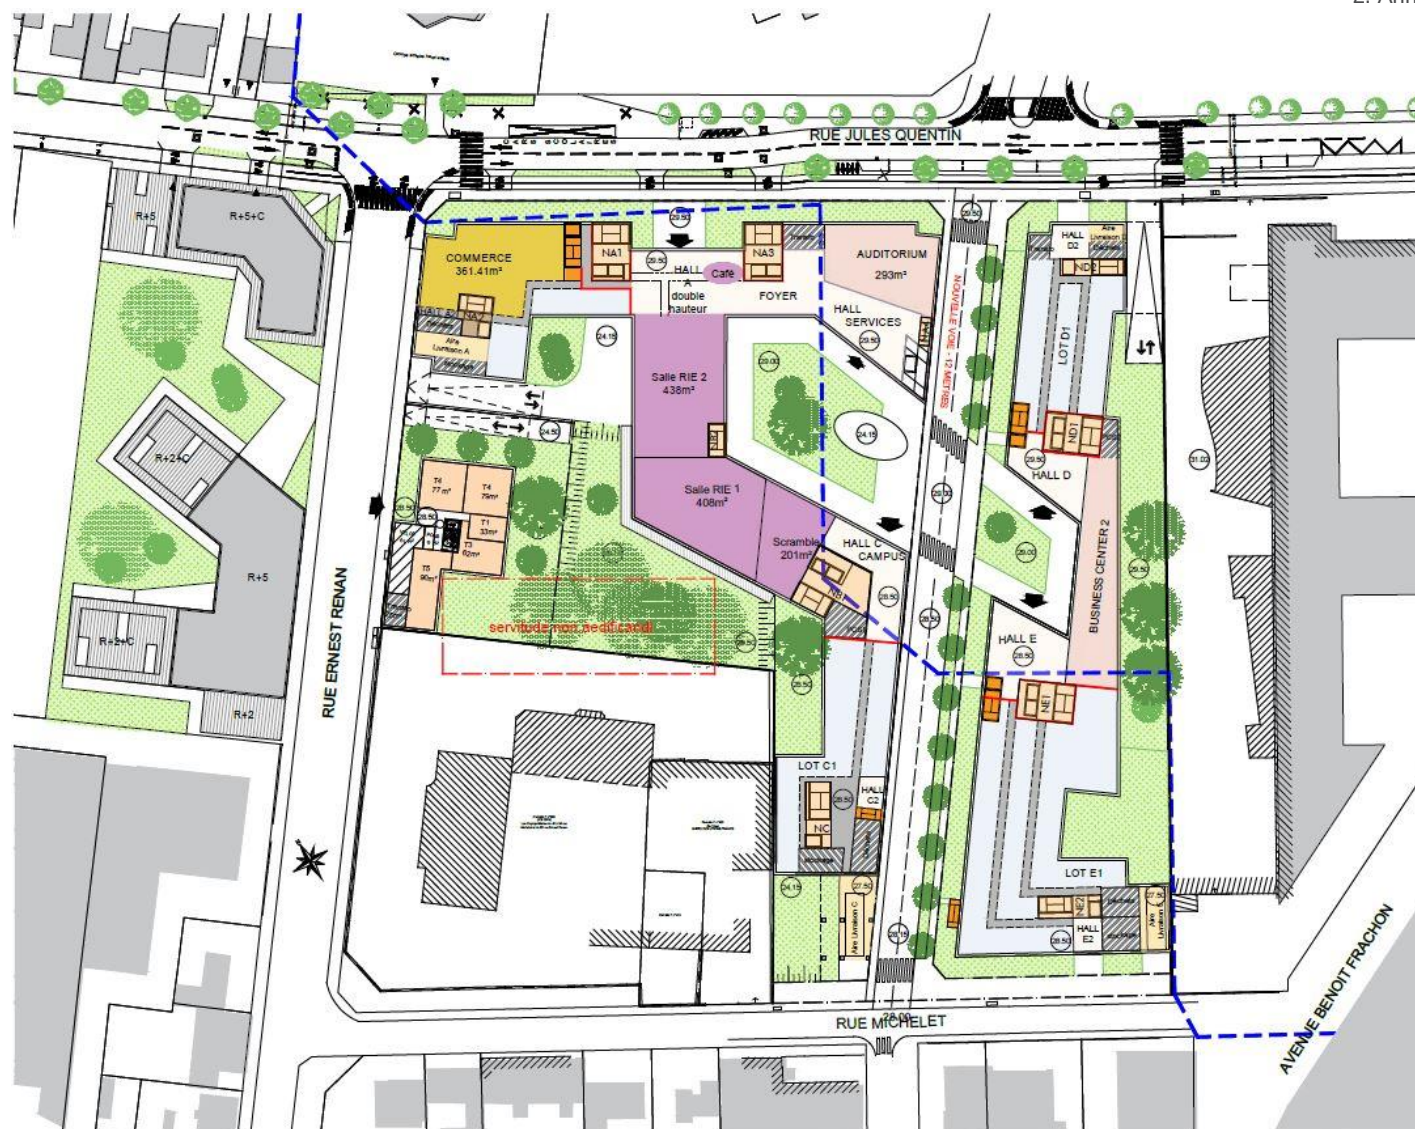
Plan du rez-de-chaussée (source : CALQ, avril 2020)
